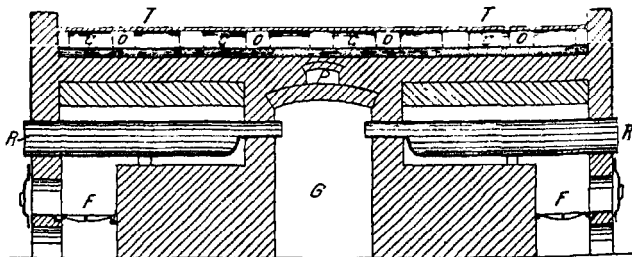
Röstofen von FÜRSTENAU. R Röhren; F Feuerung; G Gang; P Kanal für die Schwefelgase; O Kanäle (Querschnitt, C Längsschnitt) für die Trockenfläche T.
